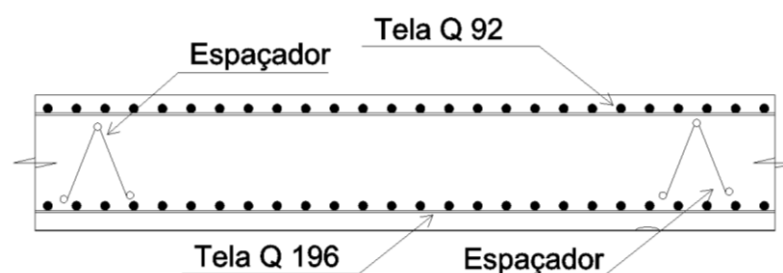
piso dimensionado com armaduras de telas soldadas.
